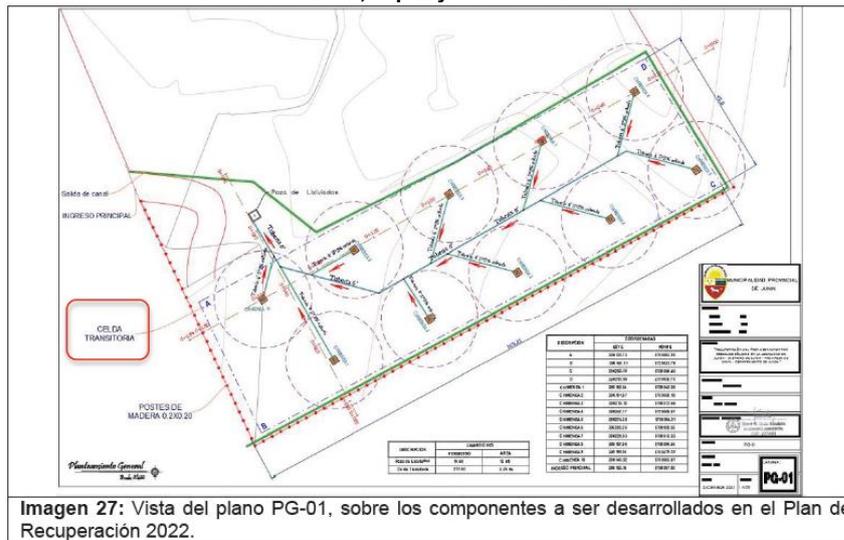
Vista del plano PG-01, sobre los componentes a ser desarrollados en el Plan de Recuperación 2022.
